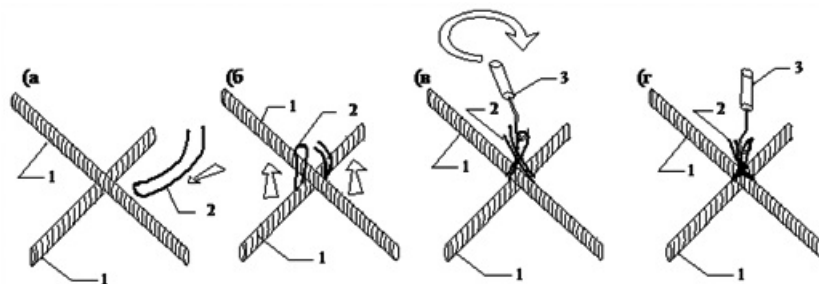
Схема фиксации арматурных стержней вязальной проволокой:
